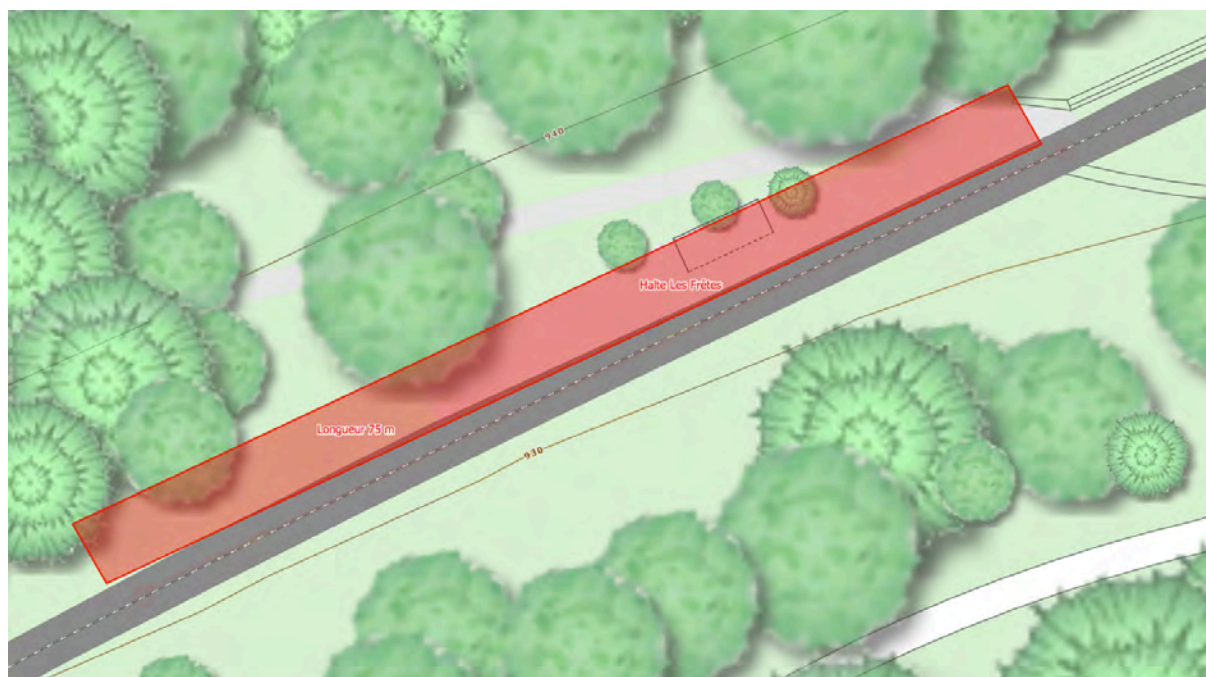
Plan d'installation d'un quai de 75 m aux Frêtes ⁴⁶
